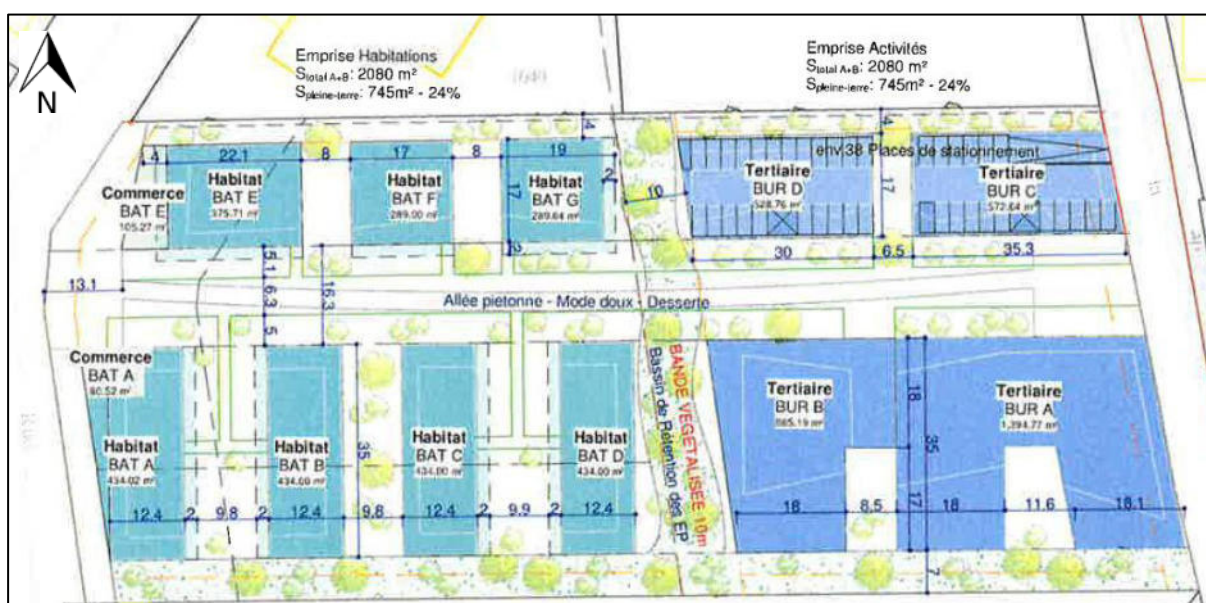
Plan masse du projet d'aménagement (Source : LEON GROSSE IMMOBILIER)
